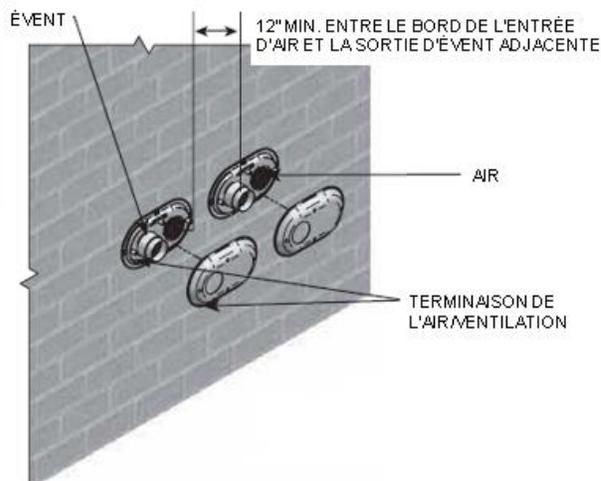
Dégagements minimaux : Terminaisons murales multiples
